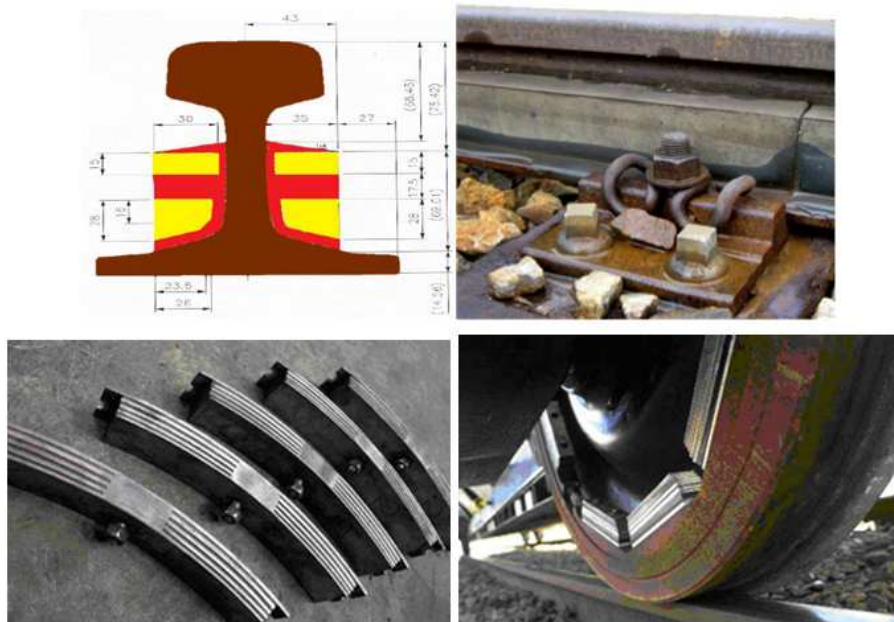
Rail Dampers em cima e Wheel Dampers em baixo (Environmental Noise Directive, 2008)
